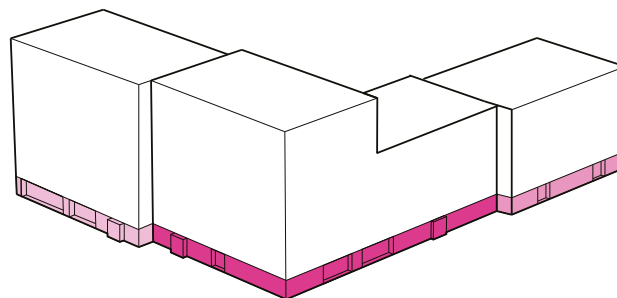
Princip for detaljering af stueetage med mindst 2 tilbagetrækninger eller fremspring på facader over 20 m.
